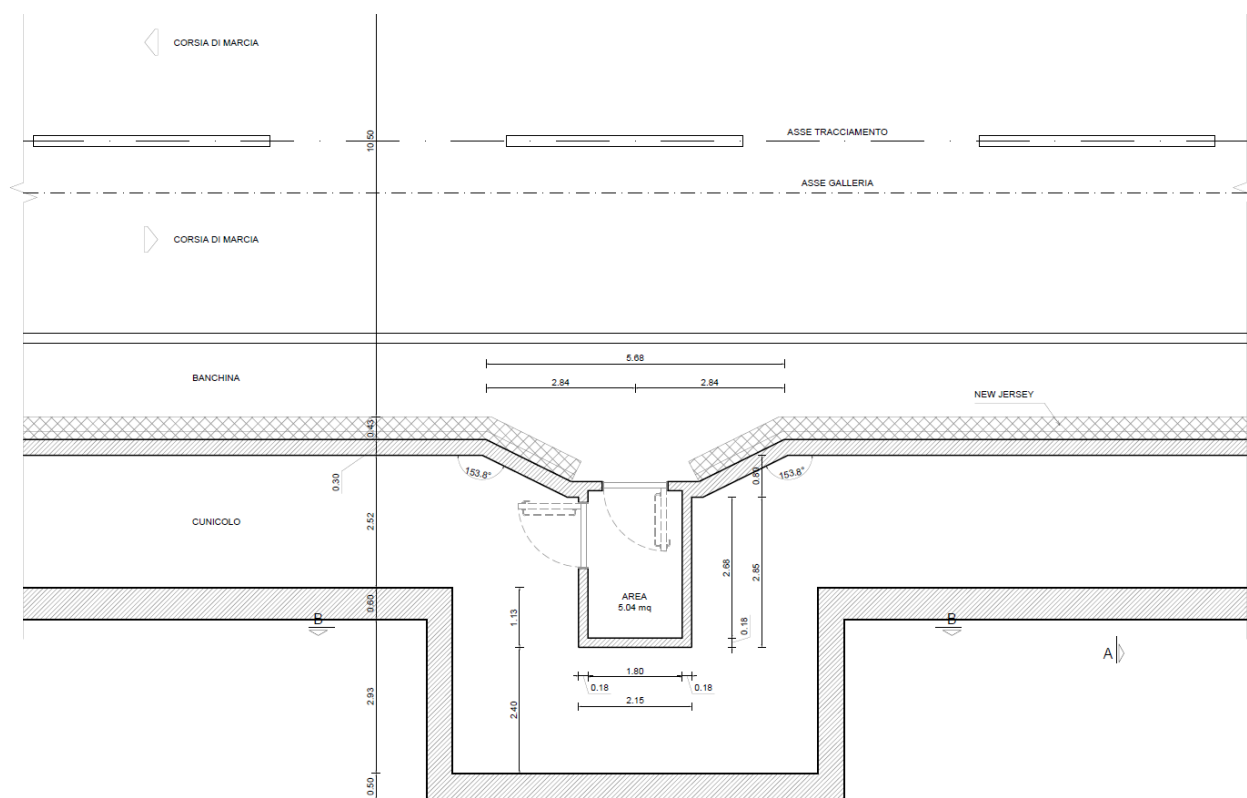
Uscita di sicurezza (sezione Planimetrica)
